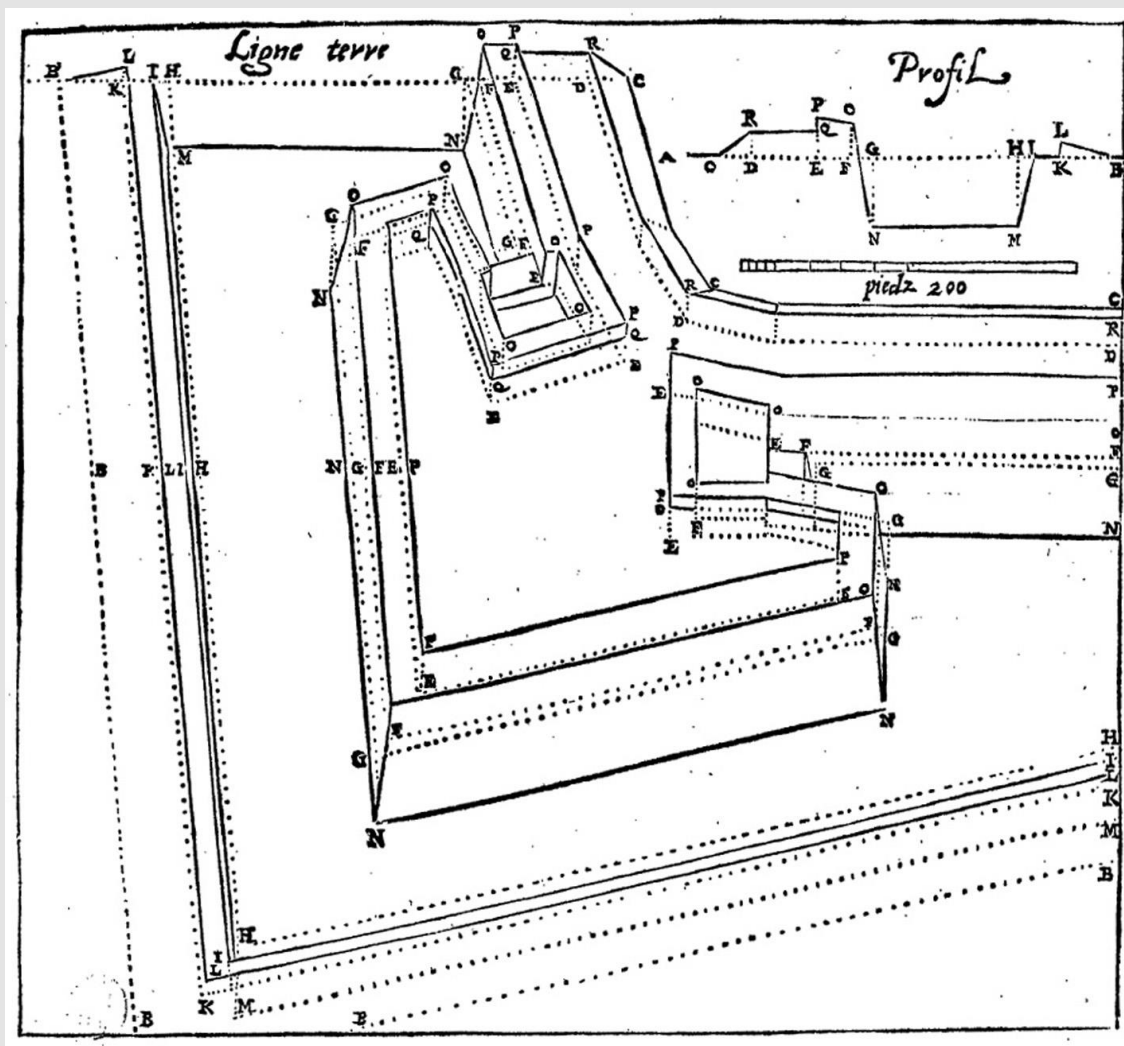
Construcción tridimensional de un baluarte a partir de líneas perpendiculares levantadas sobre el trazado de la planta, en la obra de Bachot (1598: 23).
